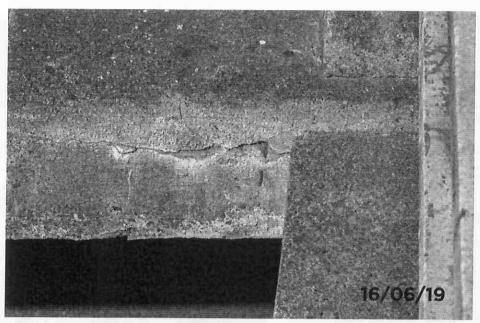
Detalhe da fissura entre o passeio e o tabuleiro.
